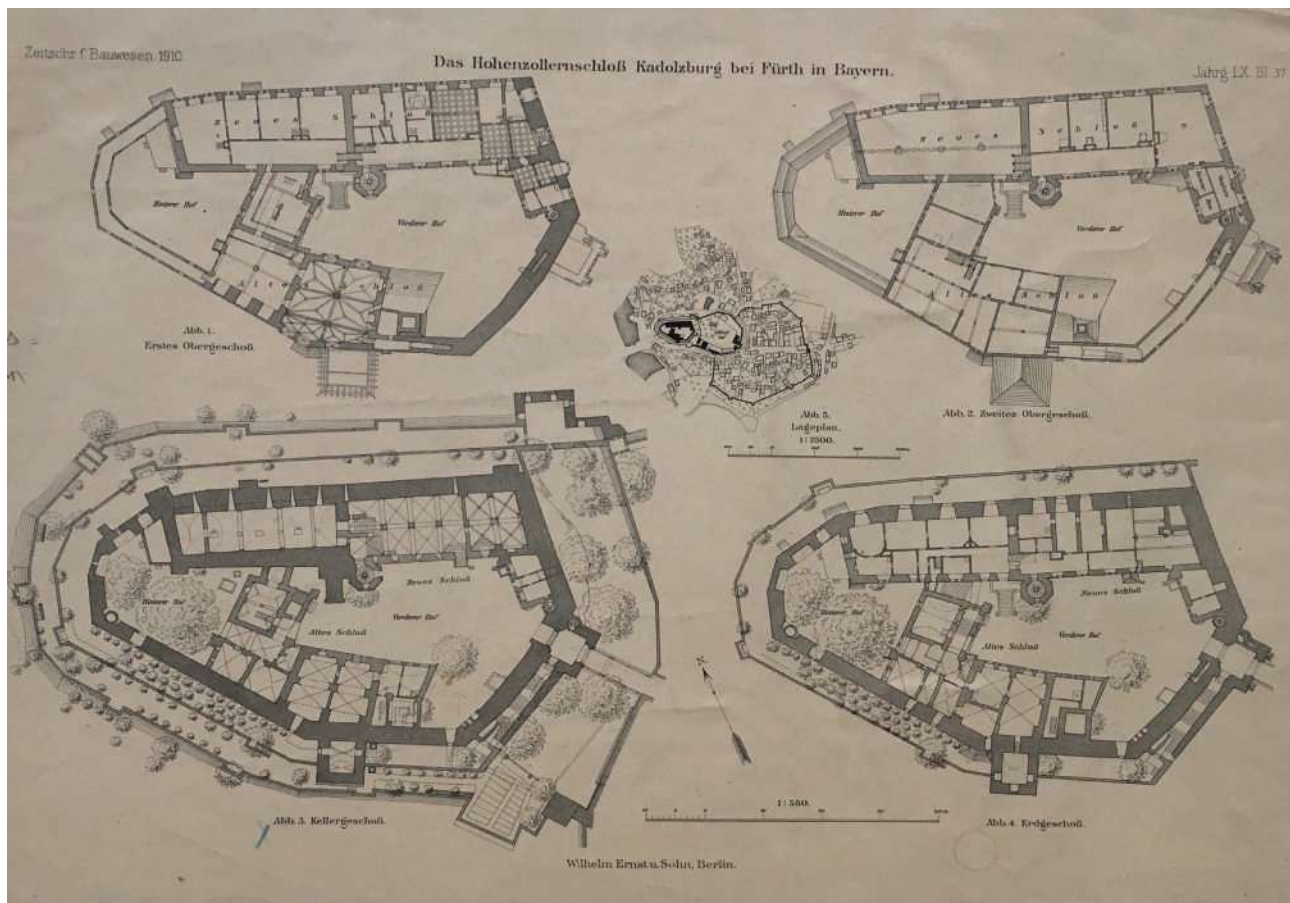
Grundrisse der Kernburg, Heinrich Thiersch, 1910
